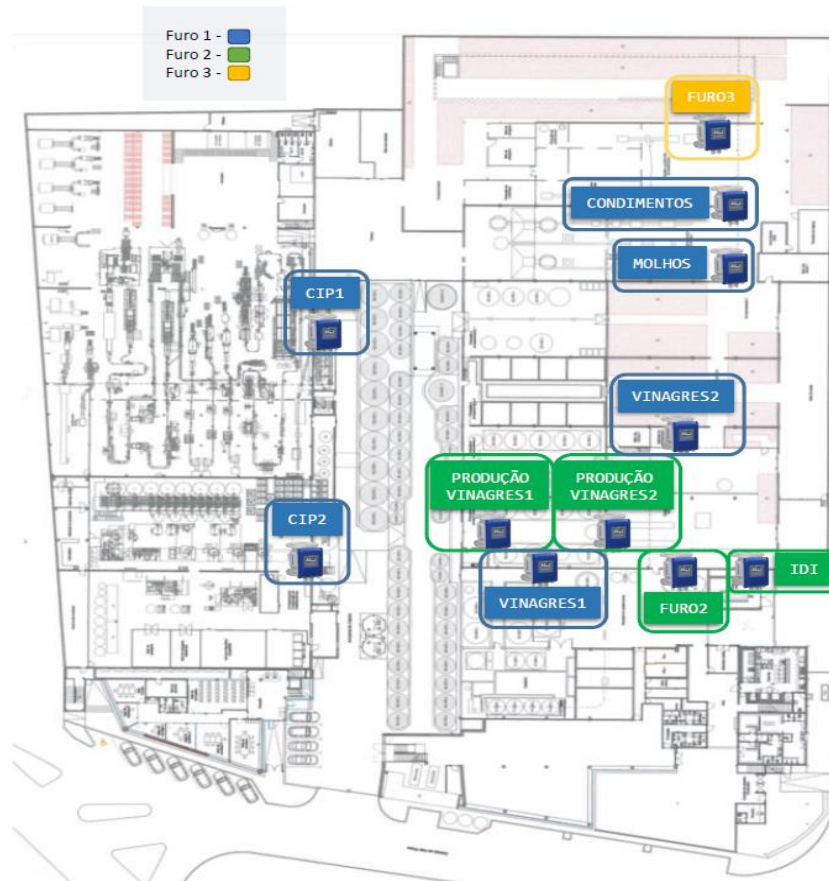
Planta da fábrica e locais onde foram instalados os caudalímetros
